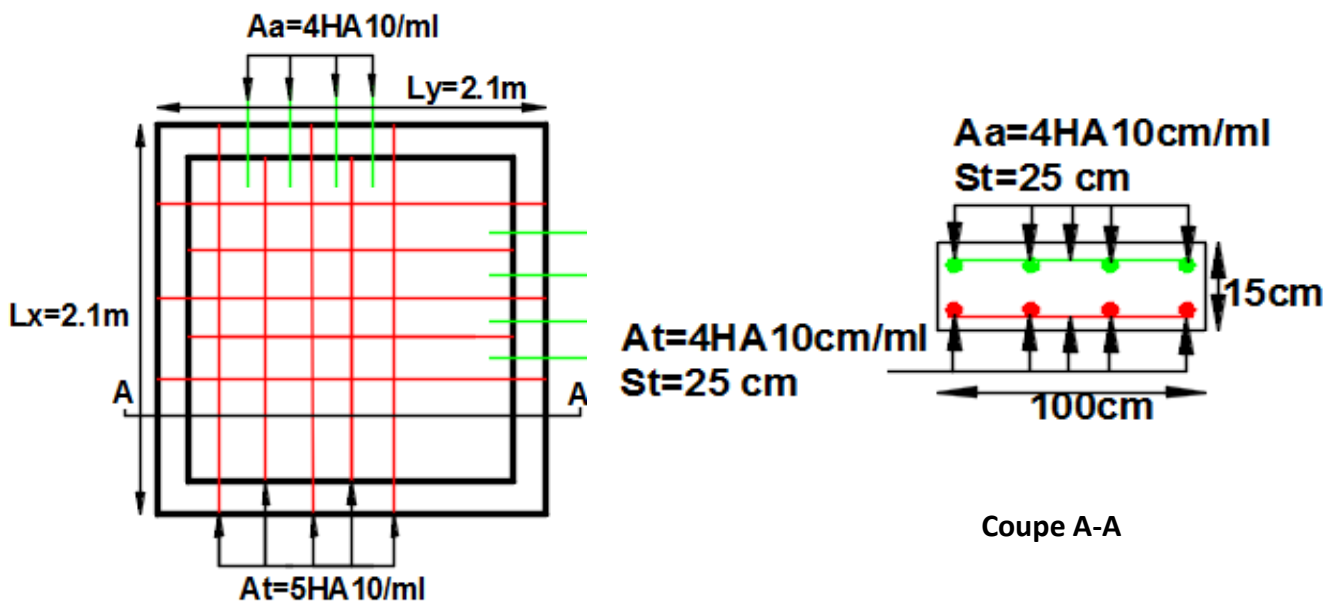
Schéma de ferrailage de la dalle pleine du local machinerie
